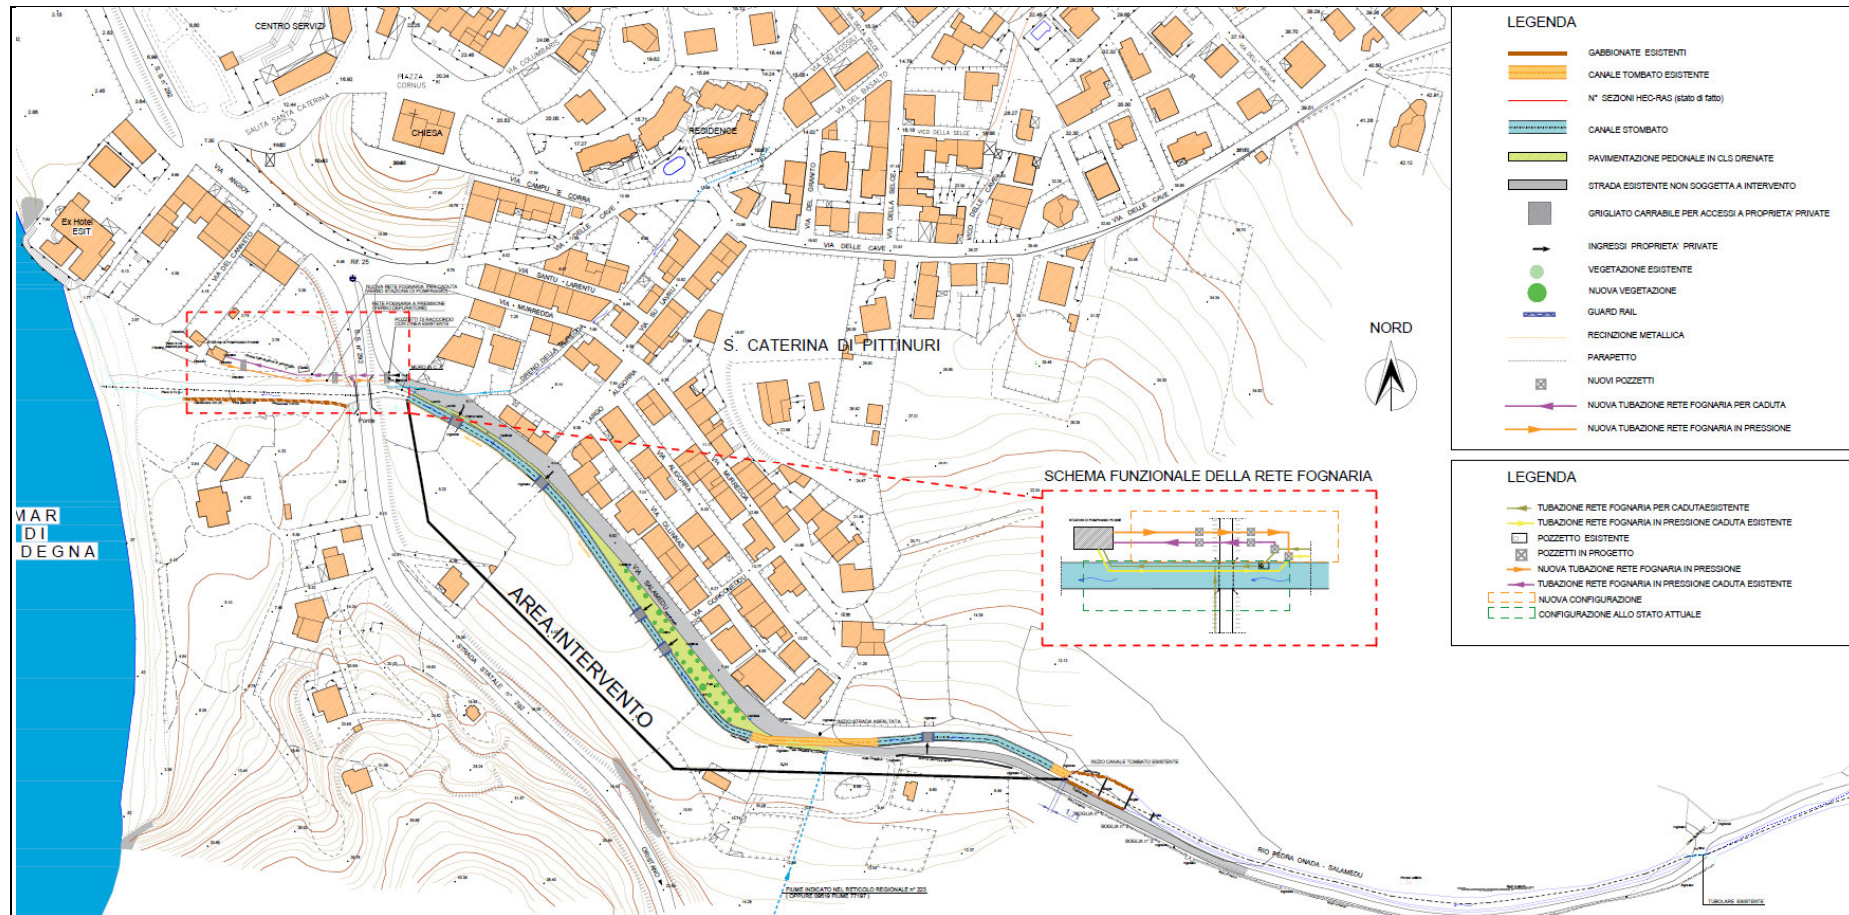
Planimetria di progetto (alternativa progettuale n. 4).
